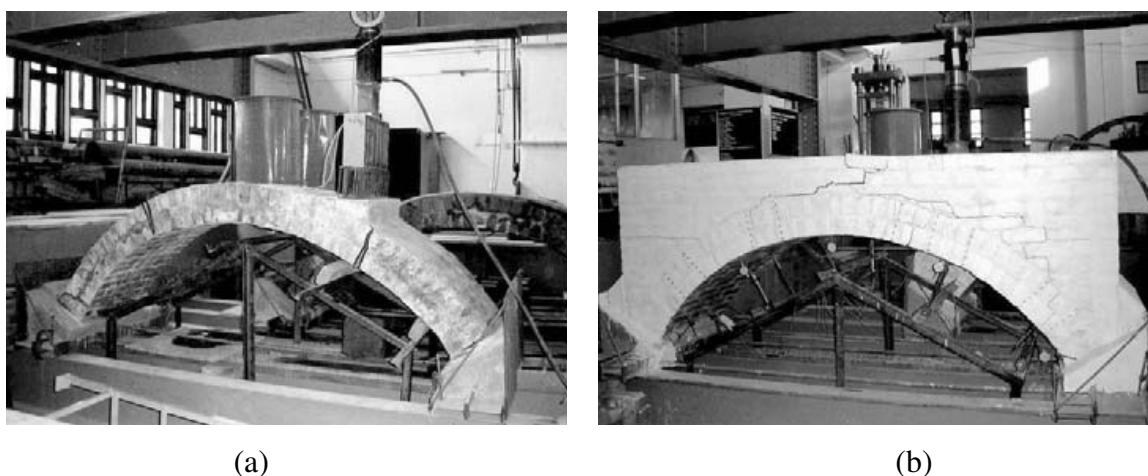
Desenvolvimento da fissuração no modelo construído em laboratório. Arco: (a) isolado; (b) com tímpano mais enchimento. Figura retirada de (PARDEEP 2006).
